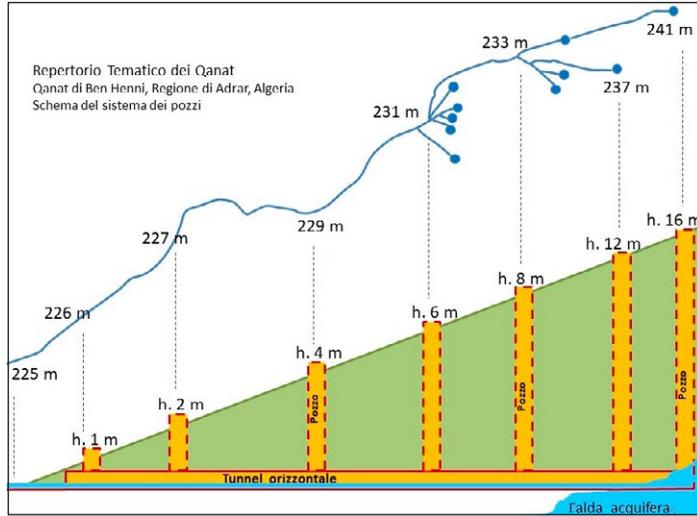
Schema planimetrico (in alto) e ricostruzione grafica in sezione del sistema di *qanat* di Ben Henni, Algeria.
